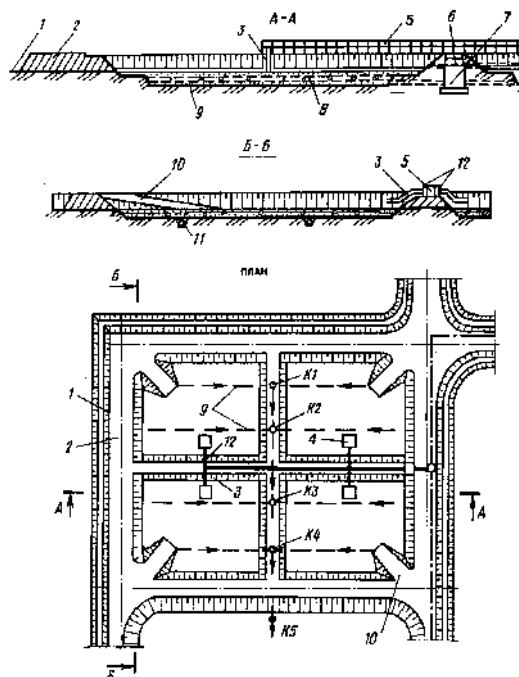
Иловые площадки на естественном основании с дренажом:
